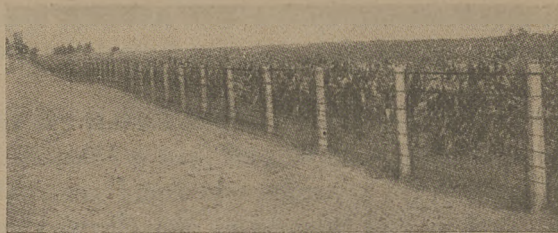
Ogrózenie plantacji przy pomocy słupów betonowych z drutu.
